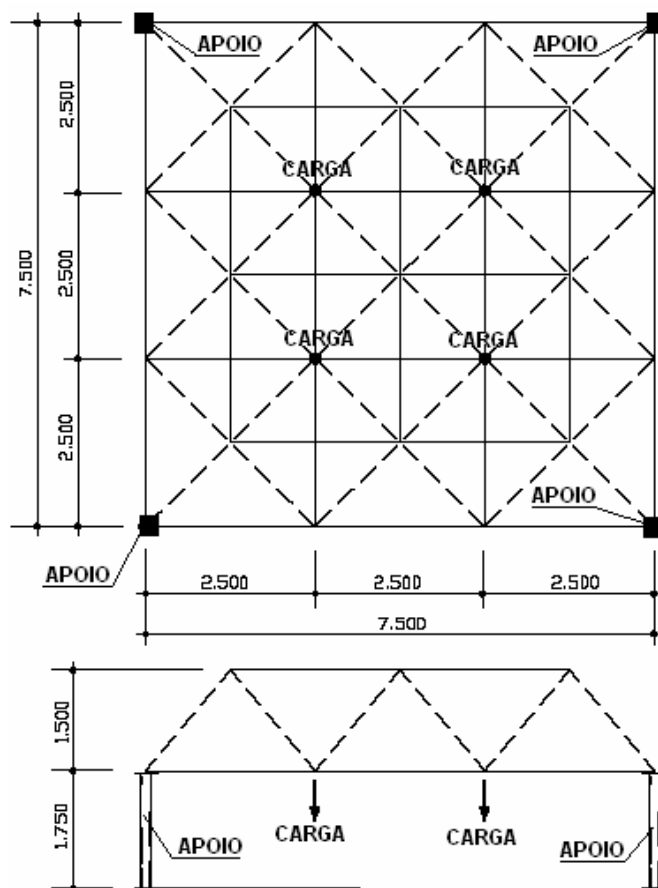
Protótipo com dimensões em planta de 7,5x7,5m (Souza, 2003)
